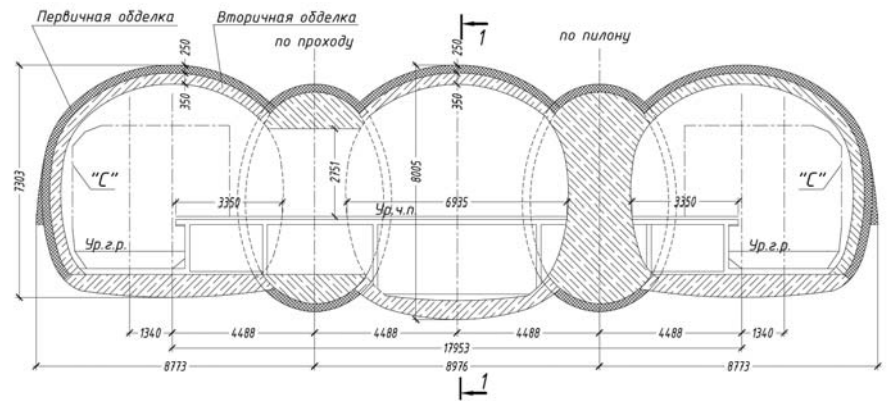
Конструктивная схема пилонной станции с двухслойной обделкой: первичной из набрызгбетона с арматурными арками, вторичной из монолитного железобетона
